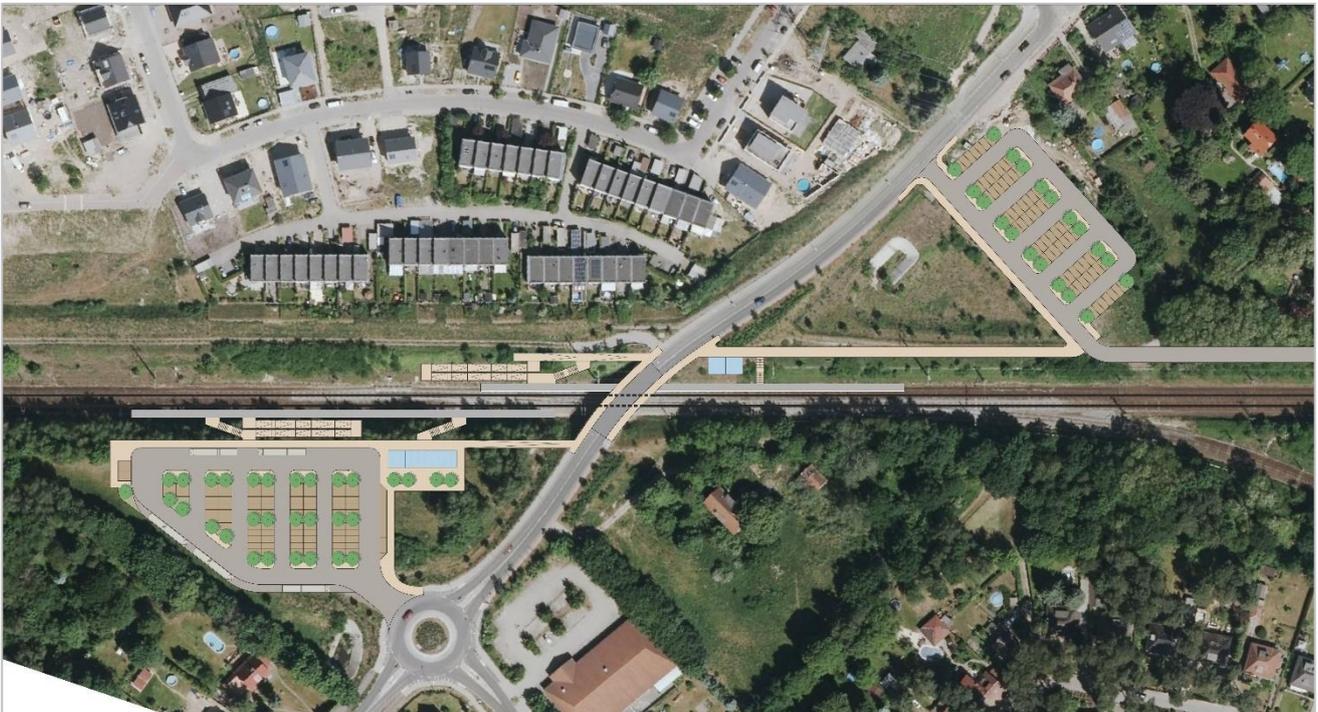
Lageplan Bahnsteige und Umfeld für Standort B
